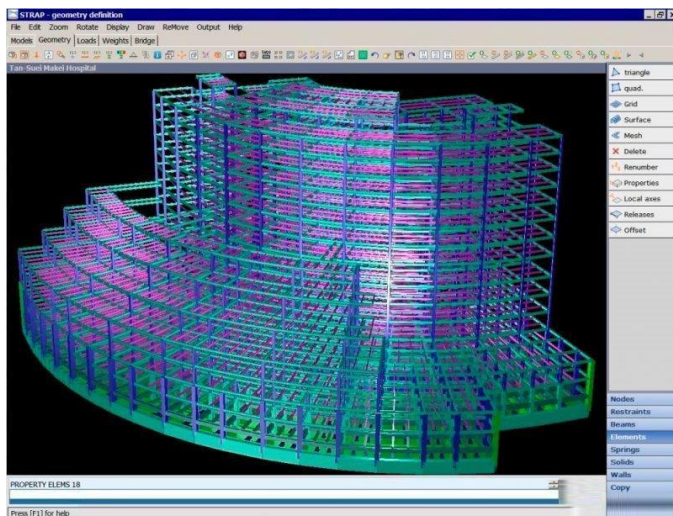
Interface do modelo 3D de uma edificação com pavimentos subterrâneos no software STRAP.
